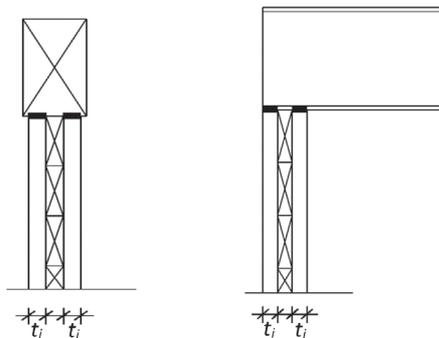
Appui de poutre sur mur en panneaux structuraux massifs bois – Largeur d'appui
